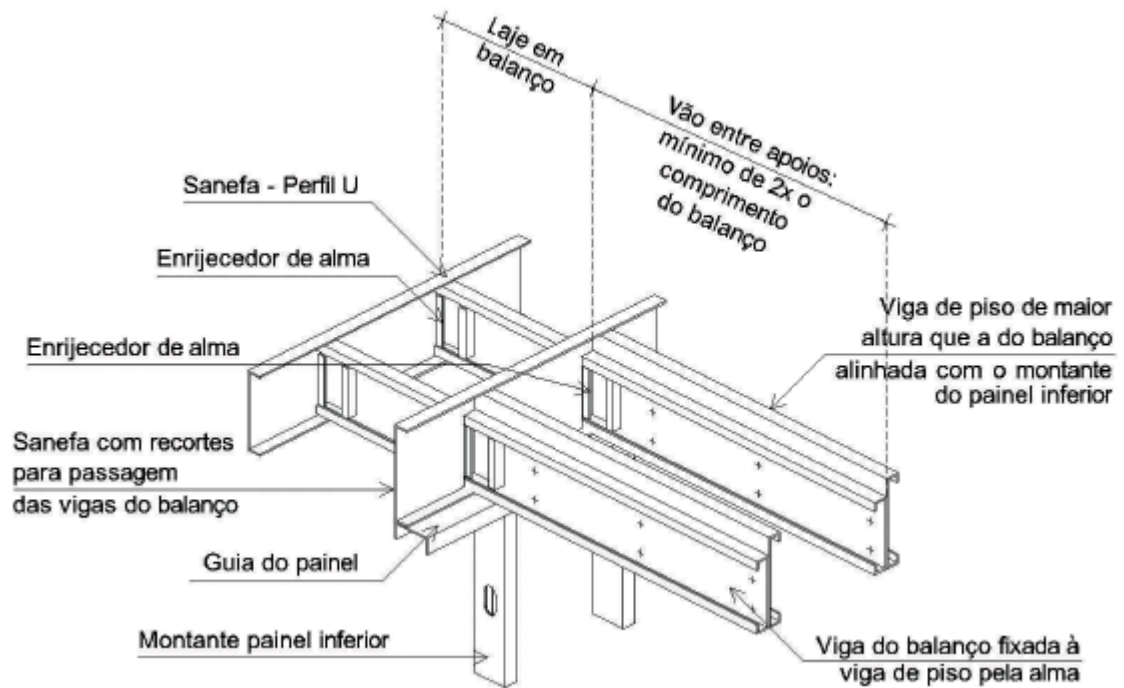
Laje em balanço na mesma direção das vigas de piso
